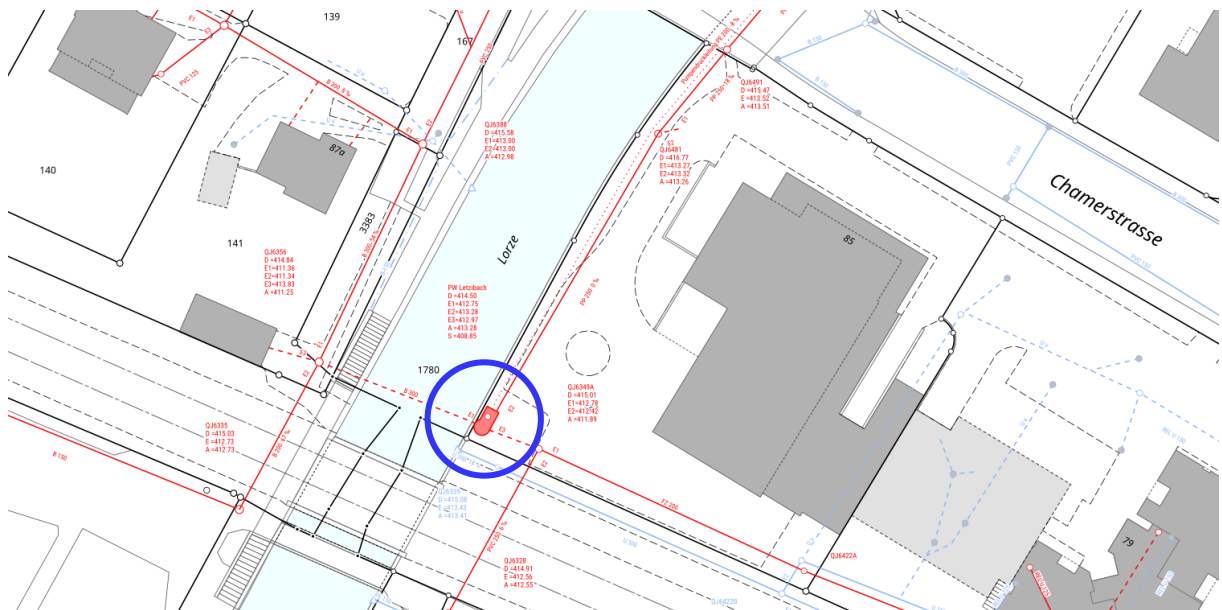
Übersichtplan inkl. Werkinformationen «Abwasser» mit Lage Pumpstation (blauer Kreis); Quelle <https://go.geodatenonline.ch> – Zugriff Stadt Zug
